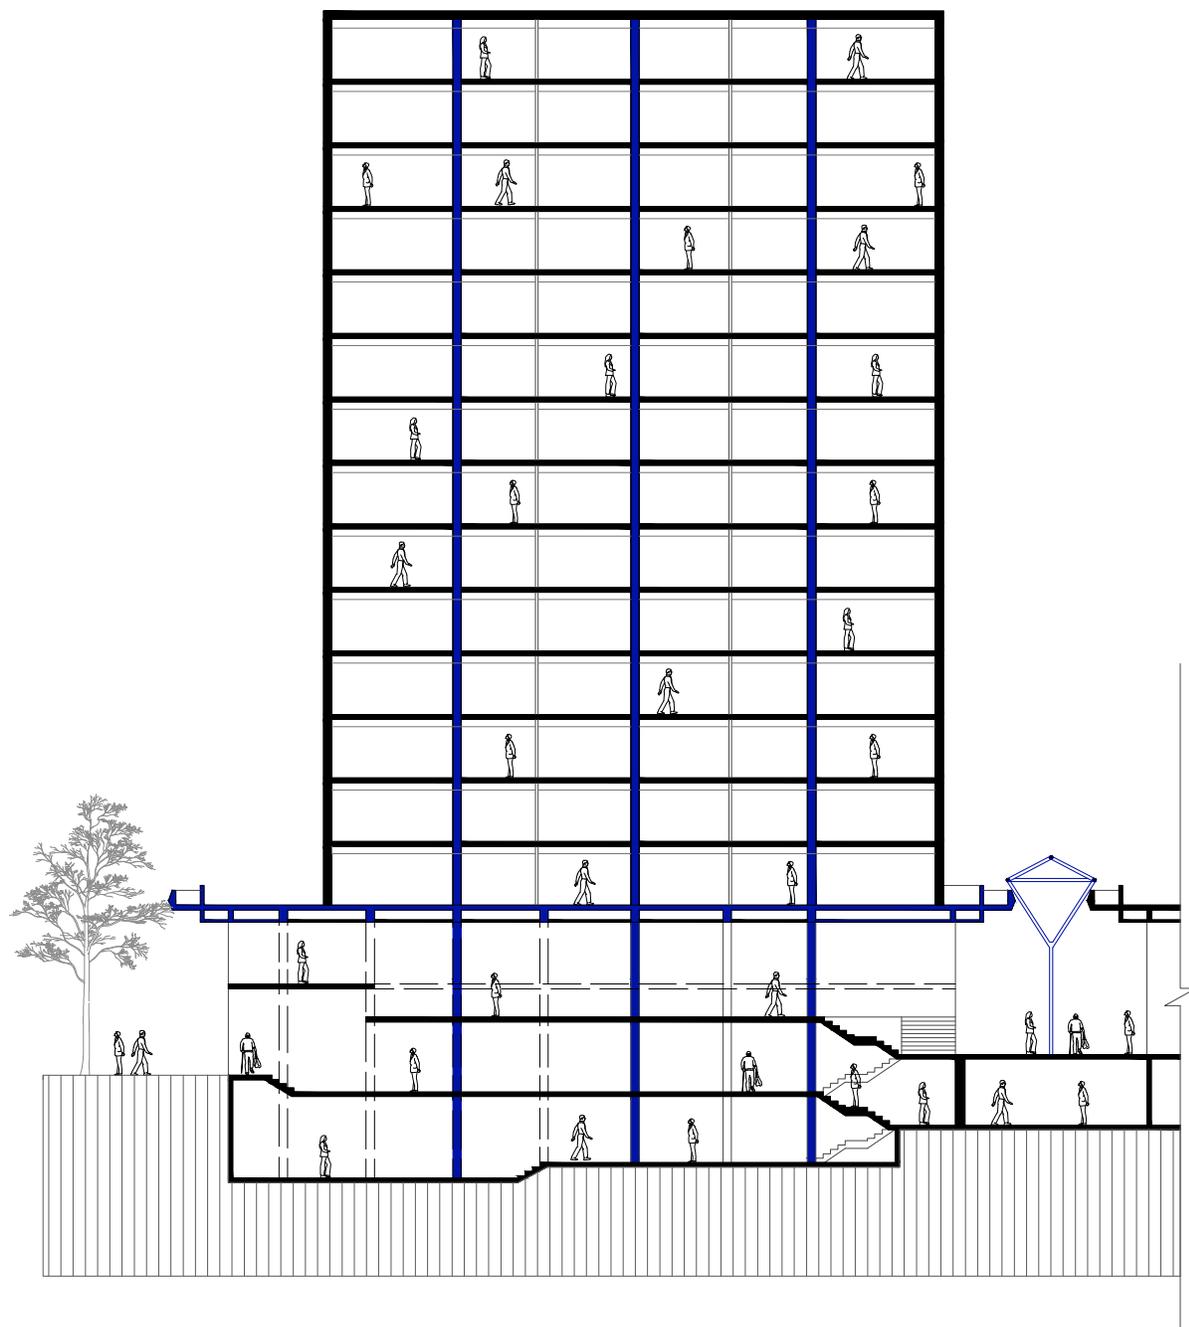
Corte Transversal Edificio Terracota. Existe una continuidad estructural de pilares del centro comercial que es utilizada por el edificio Terracota. Fuente: Elaboración Propia.
